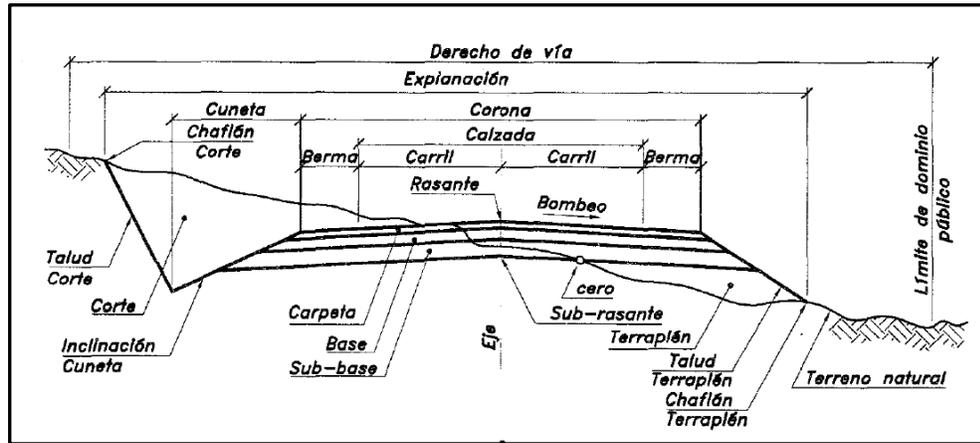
Sección transversal típica a media ladera. Cárdena G., J. (2008)
